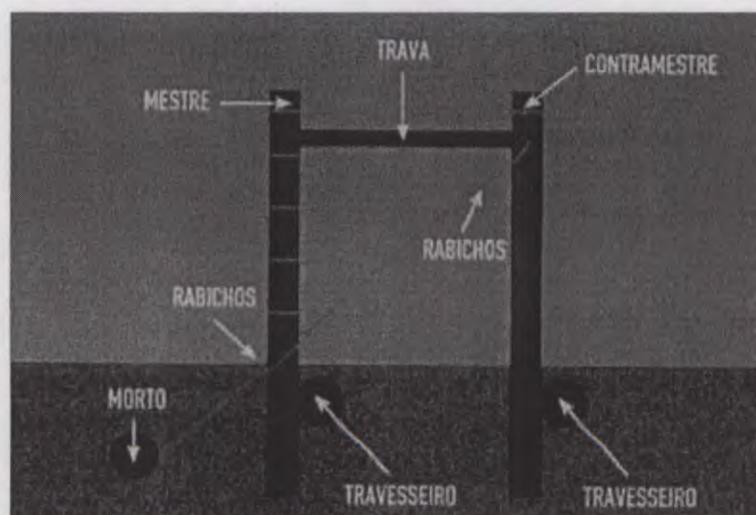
Detalhe do espaçamento entre mestre-contramestre, ou mestre-palanques na execução de cantos duplos sem ângulo, cantos duplos com ângulo e ancoragens
